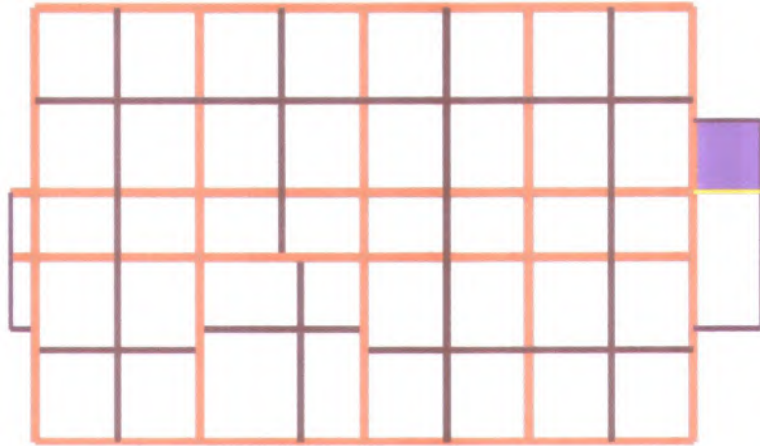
Denah posisi pembebanan gempa lantai 2 [+4.00].
